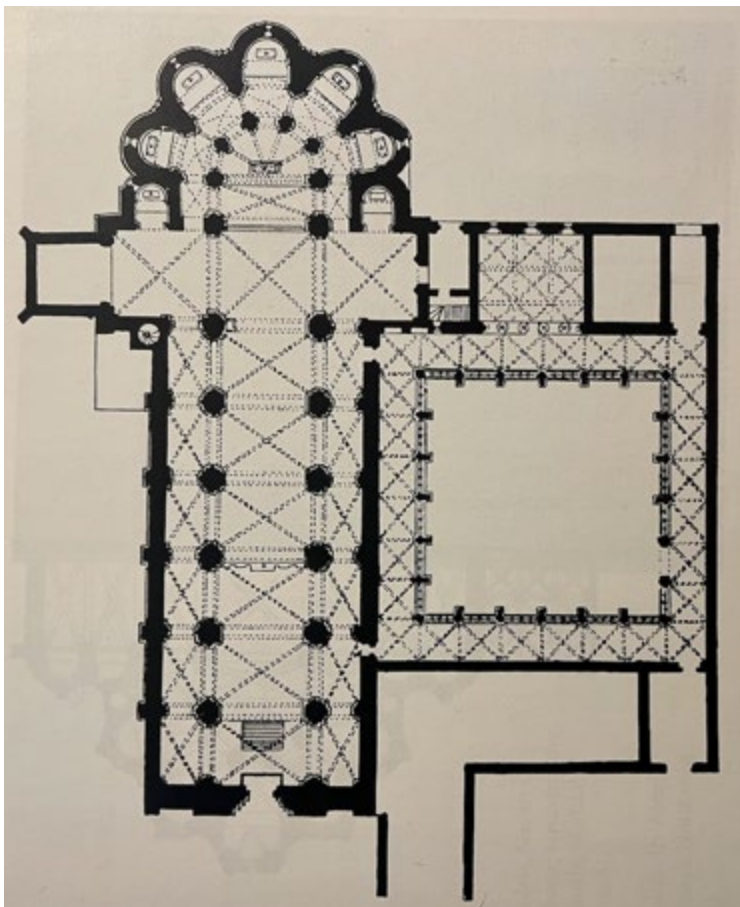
Veruela, Santa María, Grundriss der mittelalterlichen Bauteile, Street/V. Lampérez, 1908.
